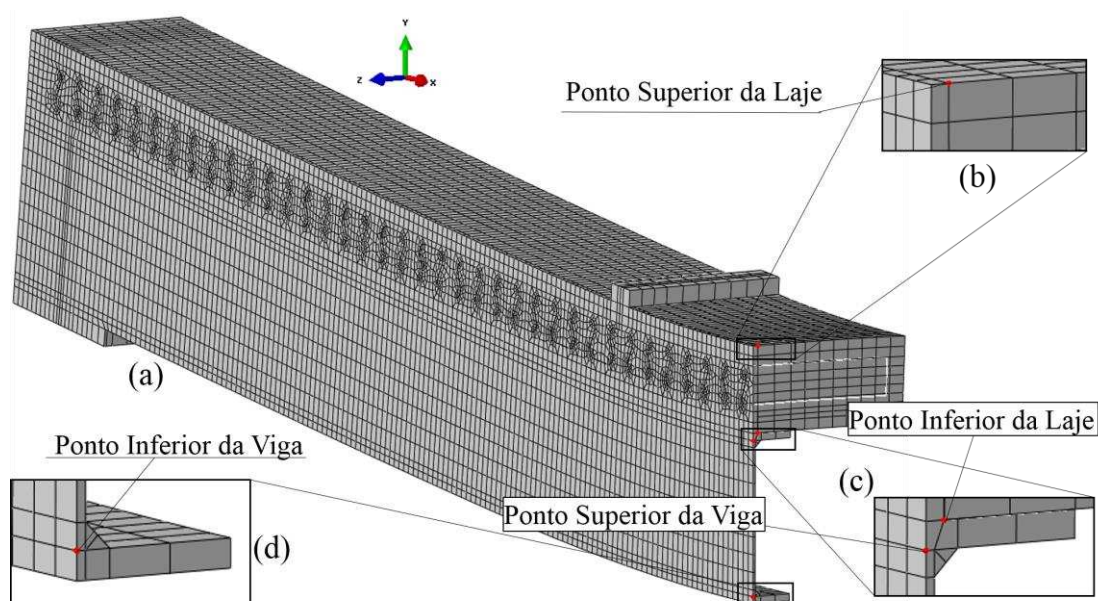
Pontos de obtenção dos resultados de deformações: (a) vista em perspectiva da viga mista deformada; (b) detalhe do ponto superior da laje; (c) detalhe do ponto inferior da laje e do ponto superior da viga; e (d) detalhe do ponto inferior da viga.
